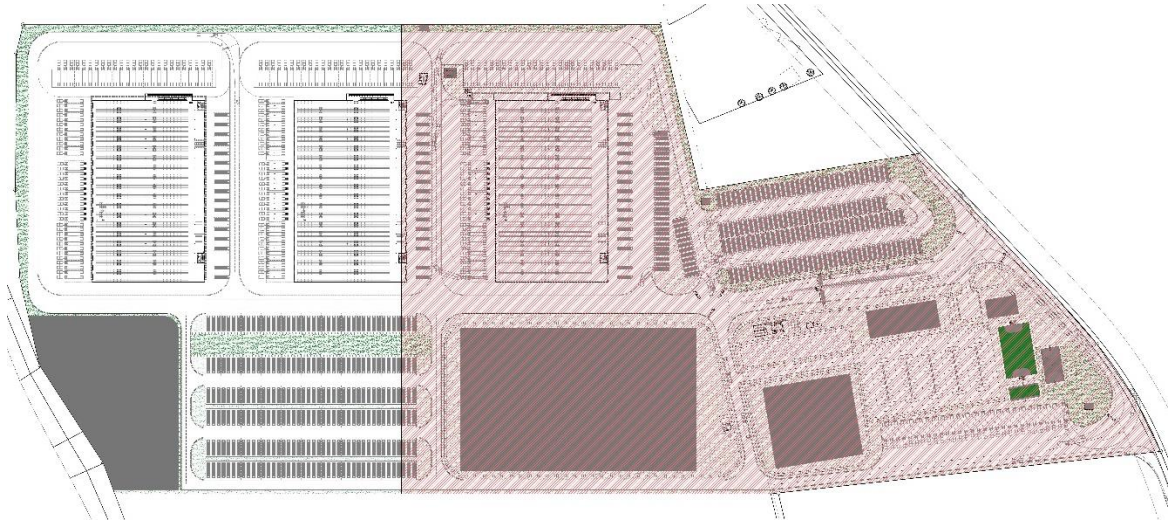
PLAN MAESTRO CEDIS-CDN
